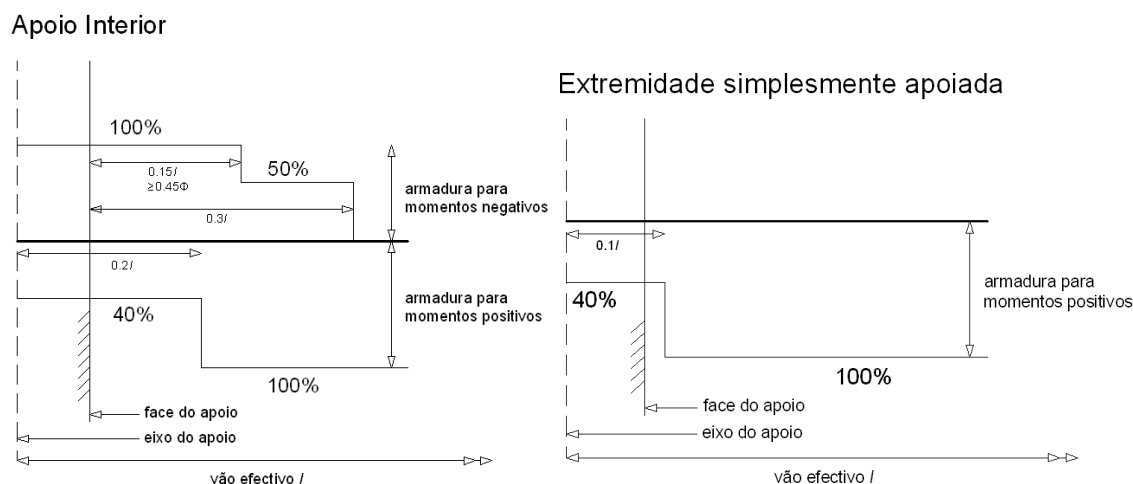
Regras simplificadas para dispensa de armaduras em lajes
